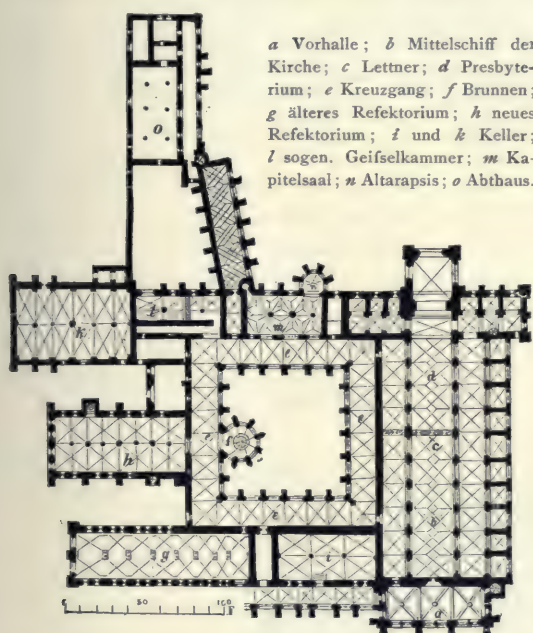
Grundriß des Klosters Maulbronn in Schwaben.
